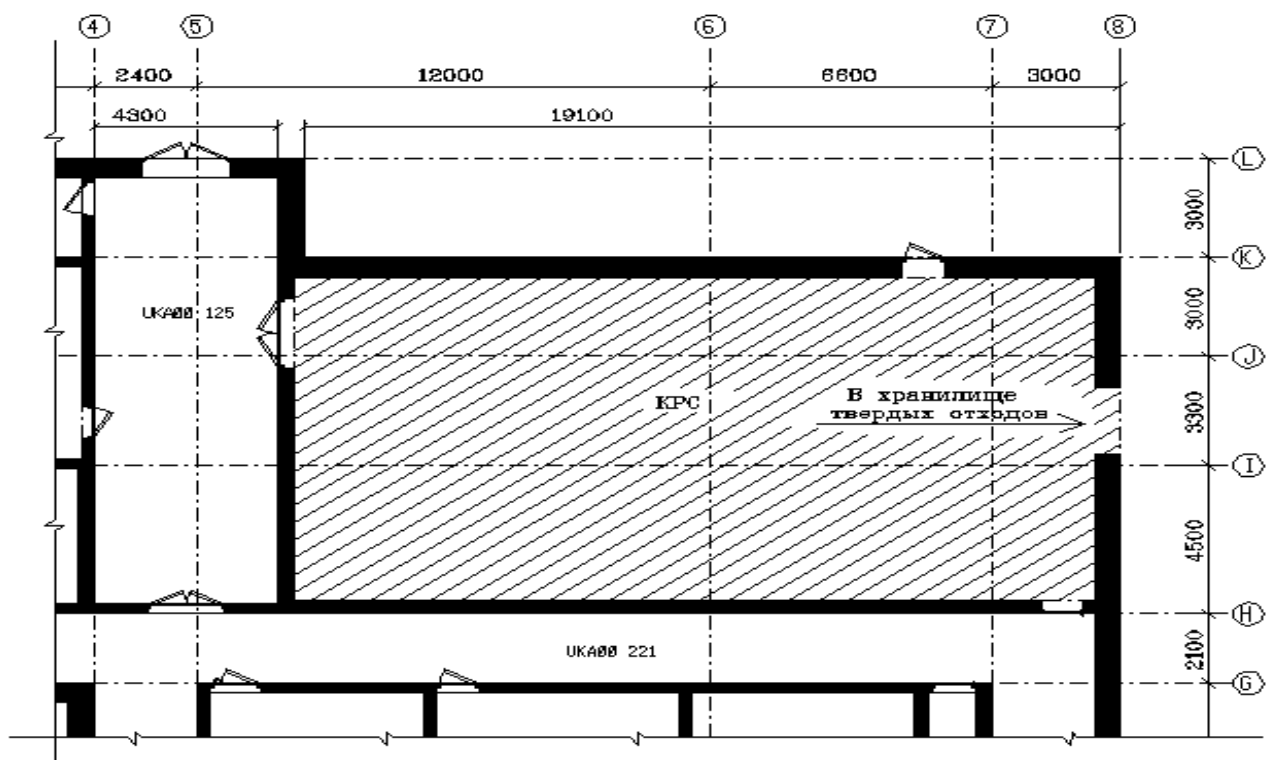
Фрагмент плана вспомогательного корпуса (УКА) для расположения оборудования установки отверждения на отм.+0,000
